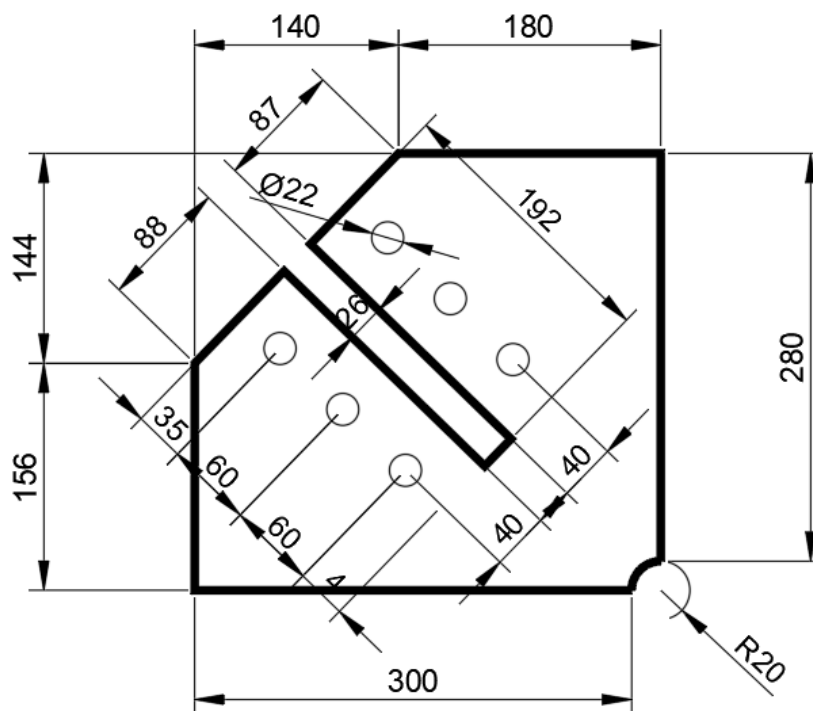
Fazzoletto d'angolo di collegamento tra diagonali di controvento e telaio.
